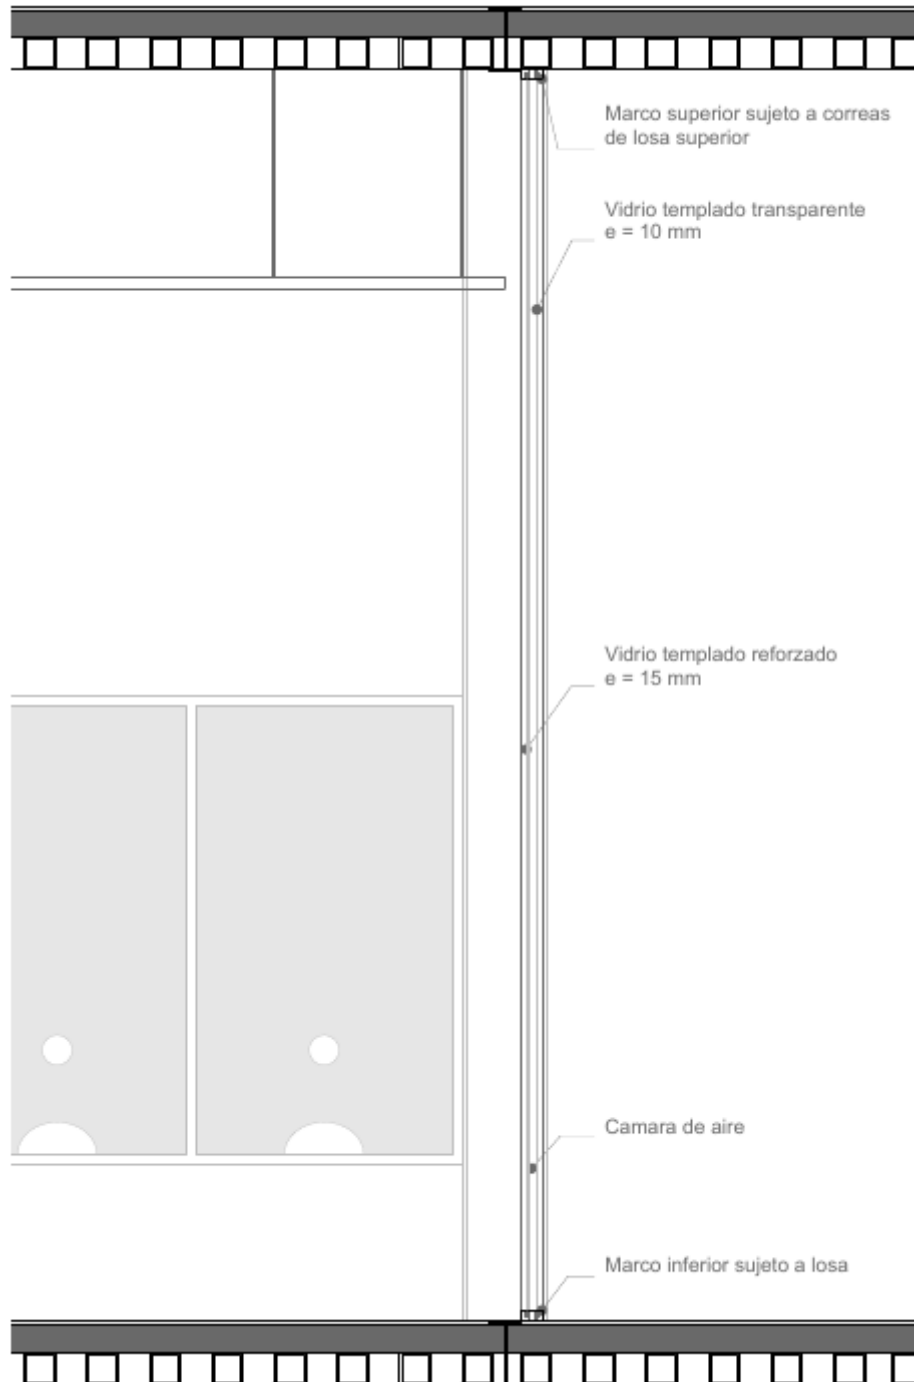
Corte detalle constructivo Bloque financiero planta nivel ± 0.00 ,
